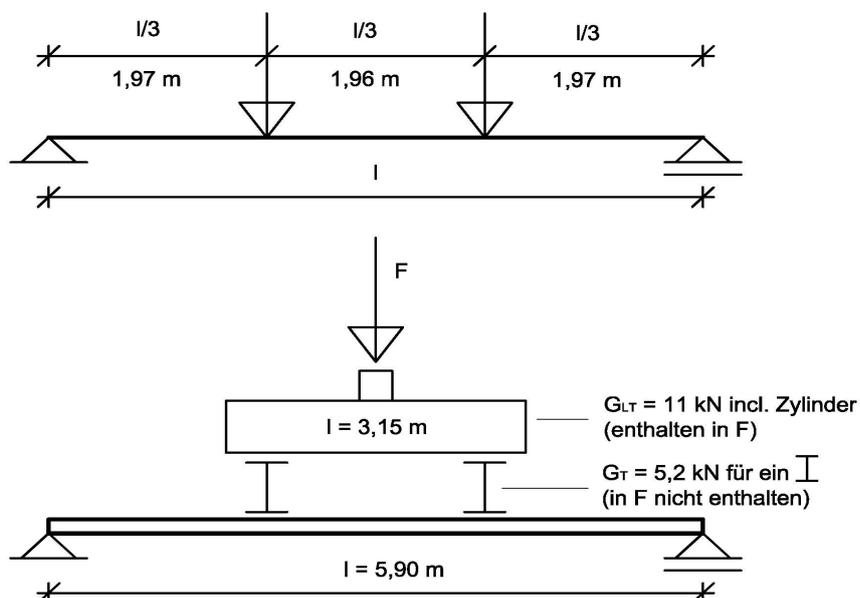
Belastungsanordnung und Einrichtung Spannbetondeckenplatte 22006
